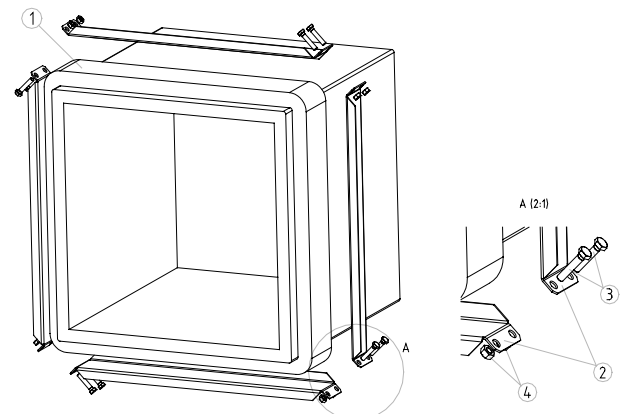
g: Embout d'étanchéité pour conduits d'air
